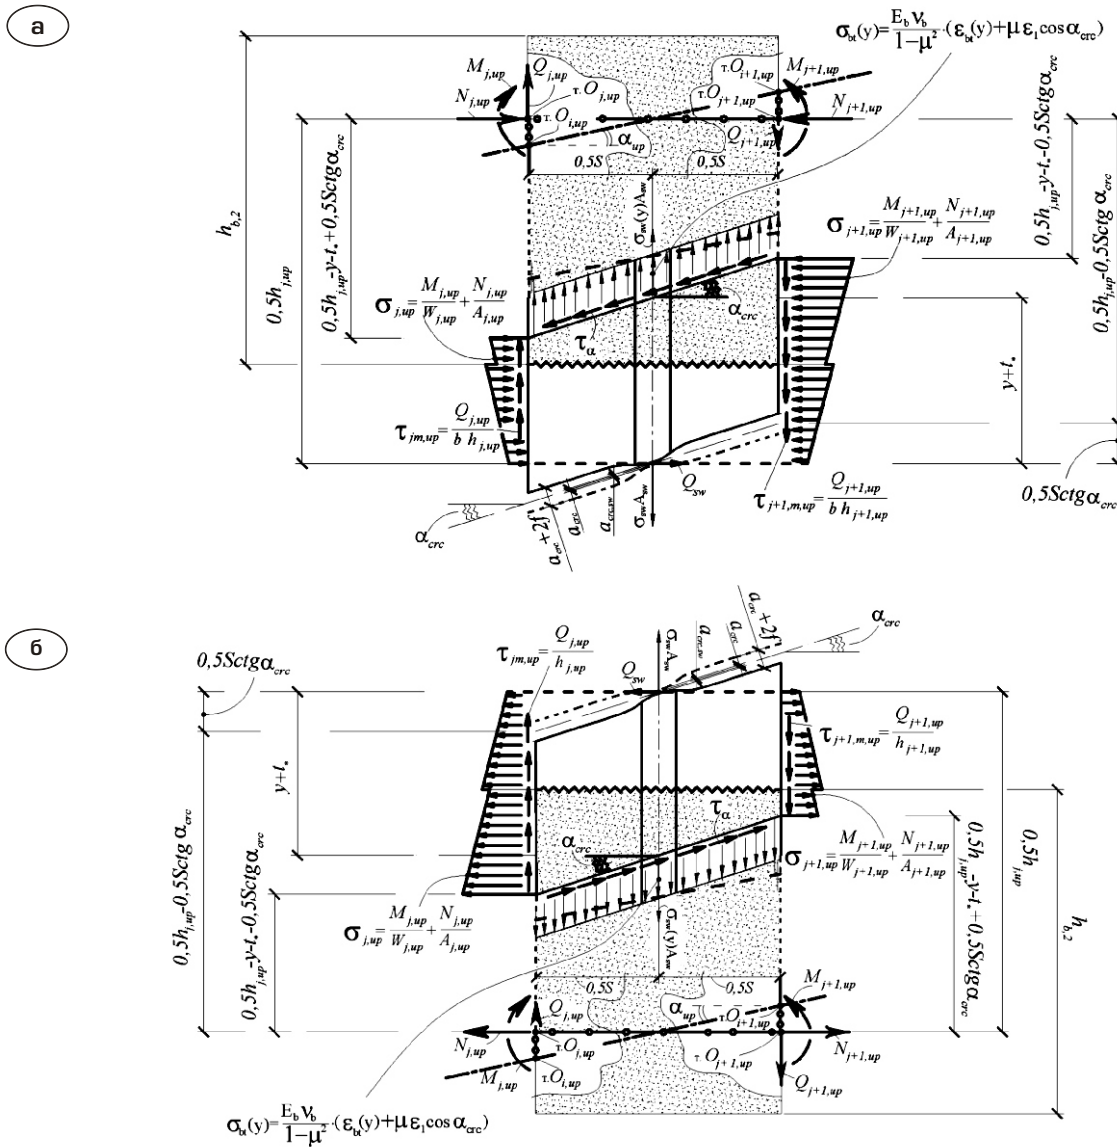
Расчетная схема к определению деформаций растянутого бетона $b_t(y)$ между наклонными трещинами первого, второго и третьего типов в железобетонной составной конструкции:
